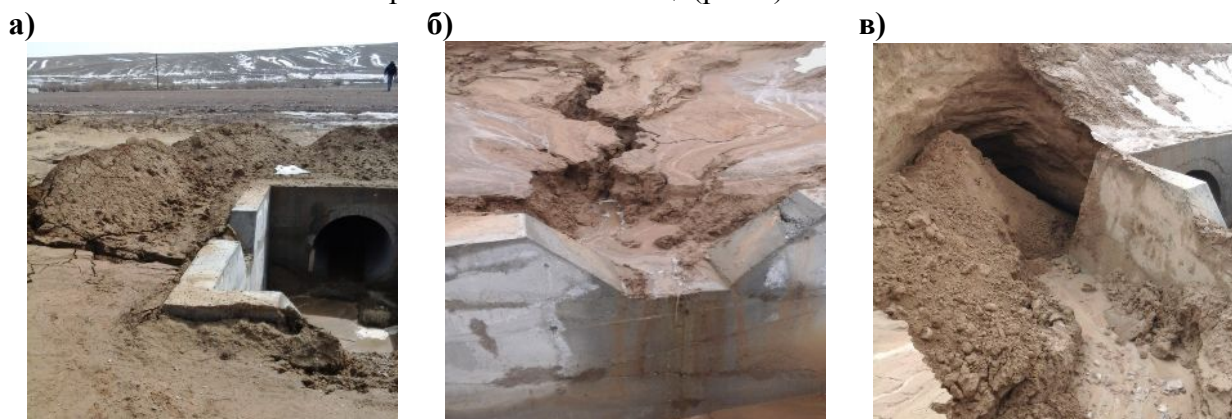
Размывы водоприемного колодца и промывы насыпи вдоль трубы:
